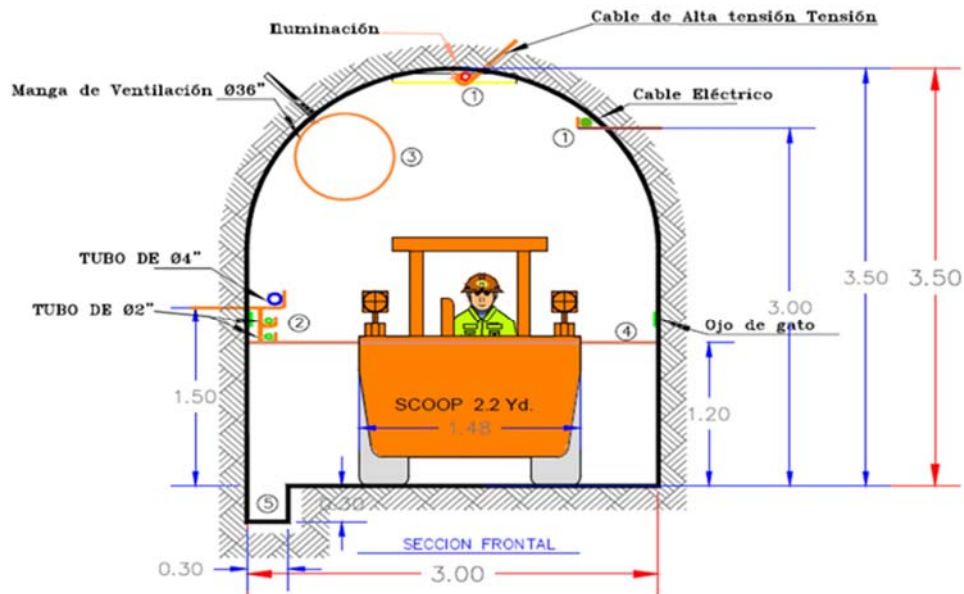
Sección Típica de Galería 3.0m x 3.5m
